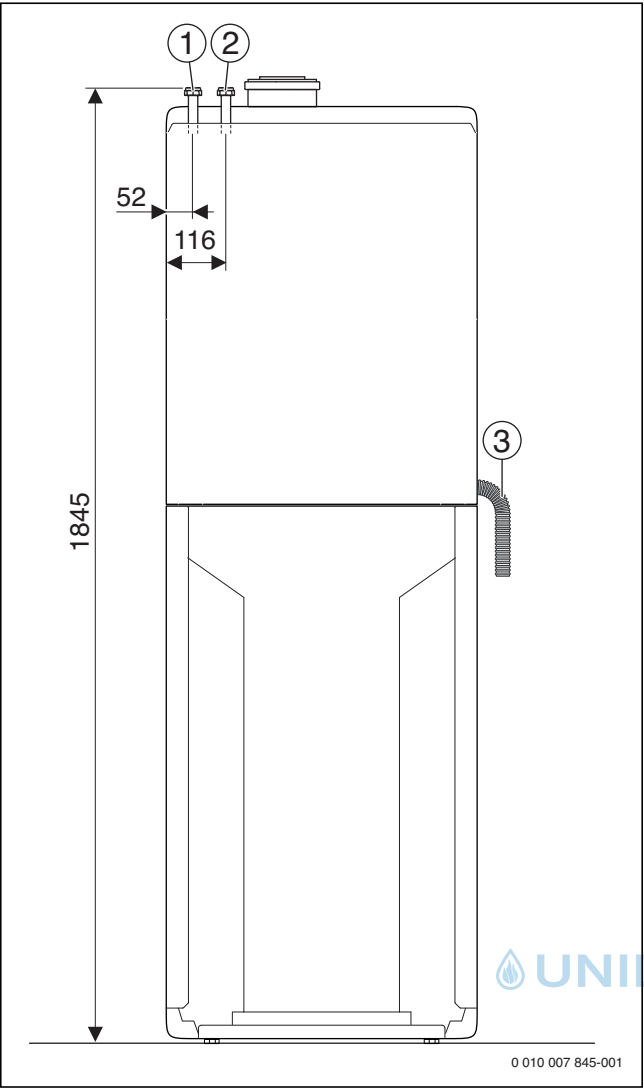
Anschlussmaße des Zubehörs CS 14 (Maße in mm)
